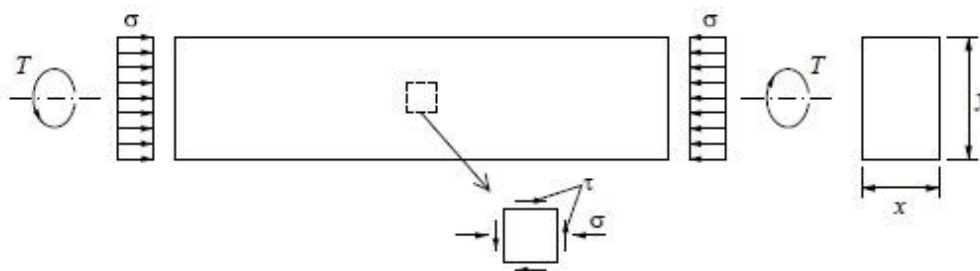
Estado de tensão numa viga sujeita à torção e a um pré-esforço longitudinal [10]
